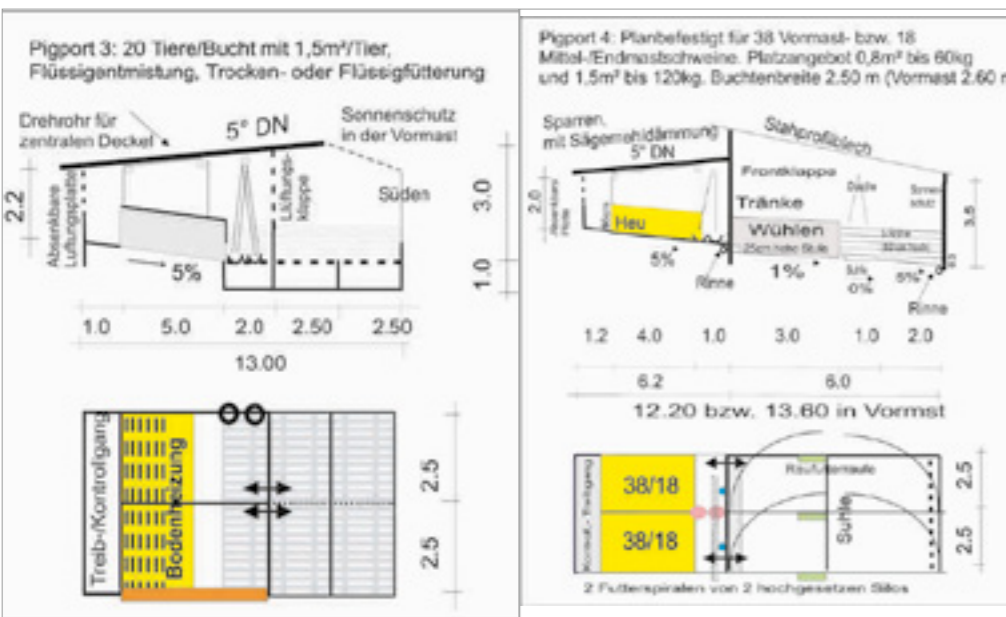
Grundriss Pigport 3, Standardverfahren mit Flüssigentmischung
